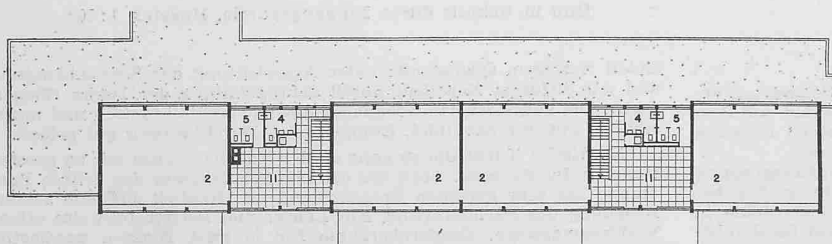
Obergeschossgrundriss, Masstab 1: 600
